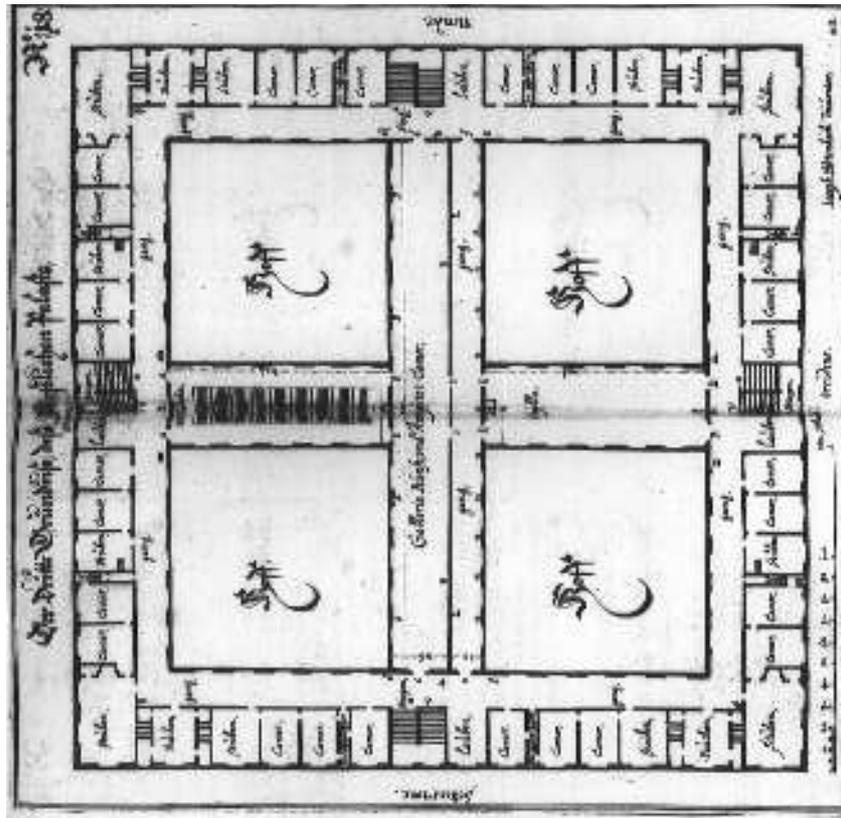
Furtenbach d. Ä., Fürstlicher Palast, Grundriß des zweiten Obergeschosses, 1640
